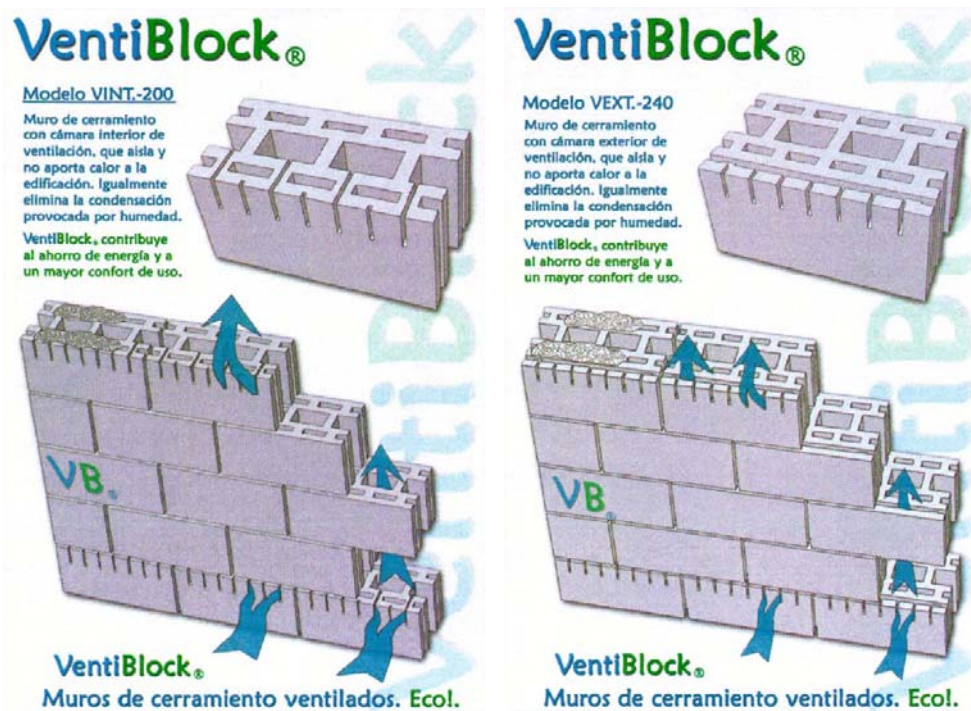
Muestras de bloque para fachada ventilada (Ventiblock®).
